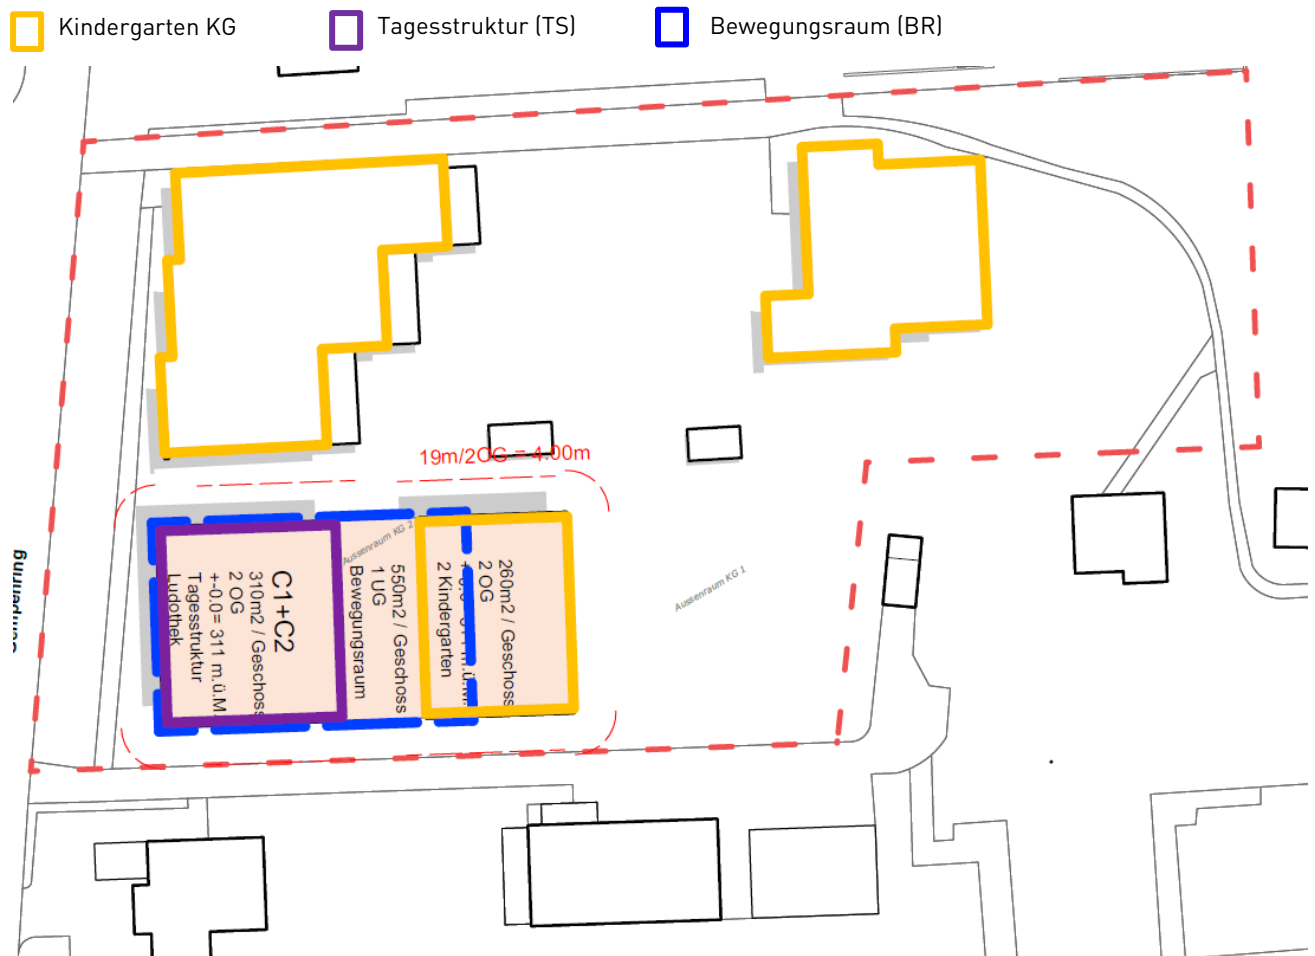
Etappe 1, Grundriss KG, BR, TS
